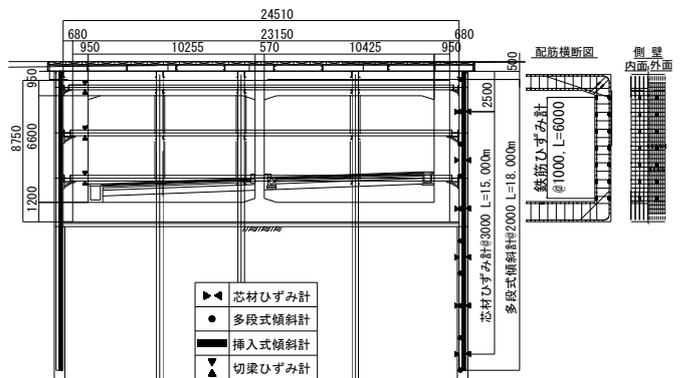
土留め計測位置と鉄筋ひずみ計測断面図
